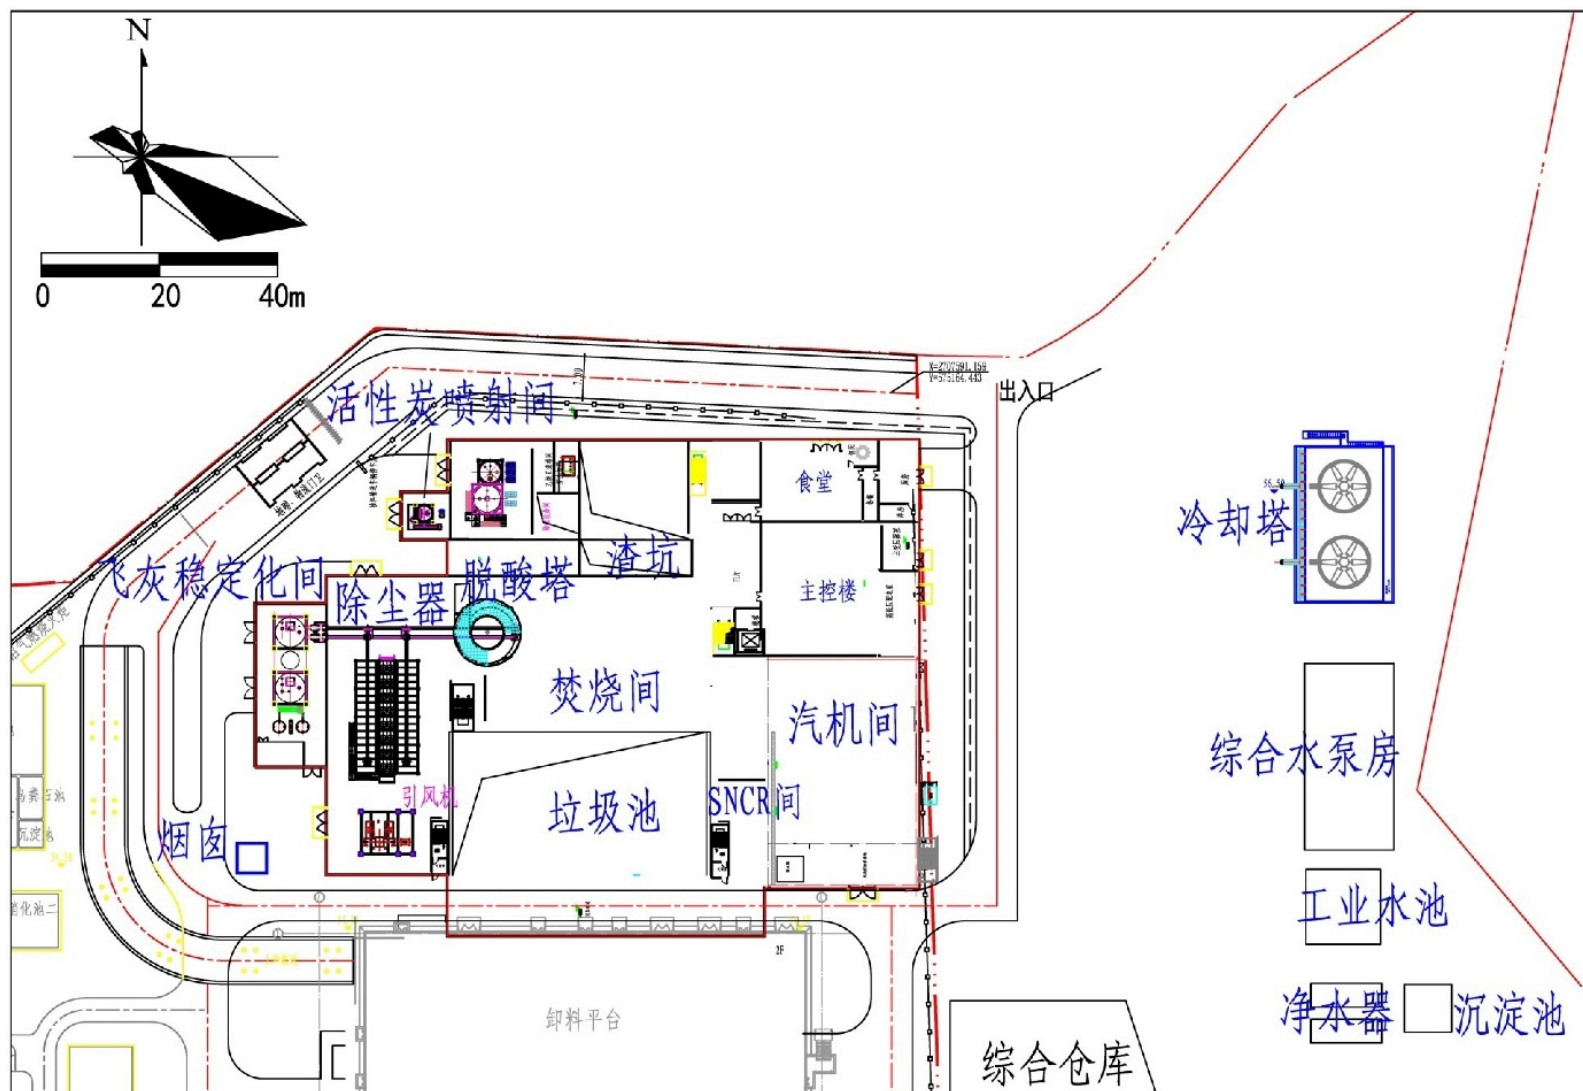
(c) 项目二期主厂房平面布置图 (二)
